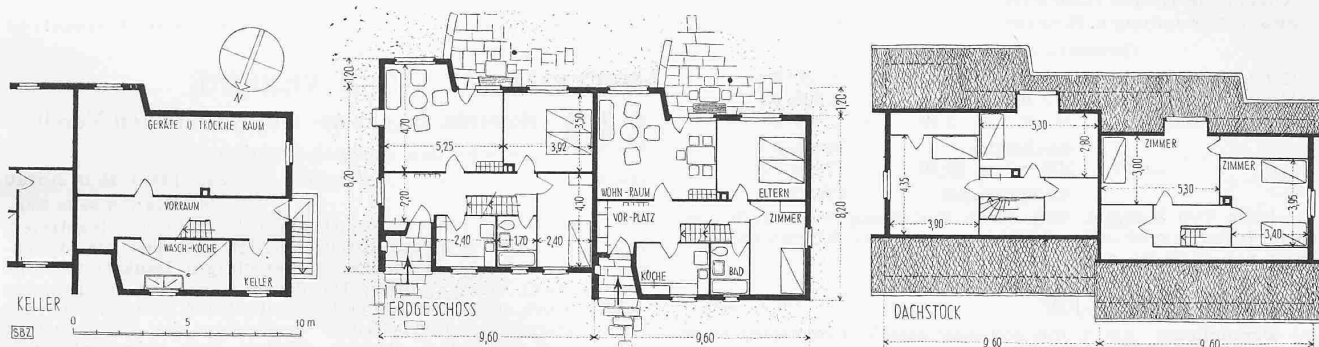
bis 5. Siedlung Wiesental, Kilchberg bei Zürich. Grundrisse Haustyp A, Masstab 1:300
